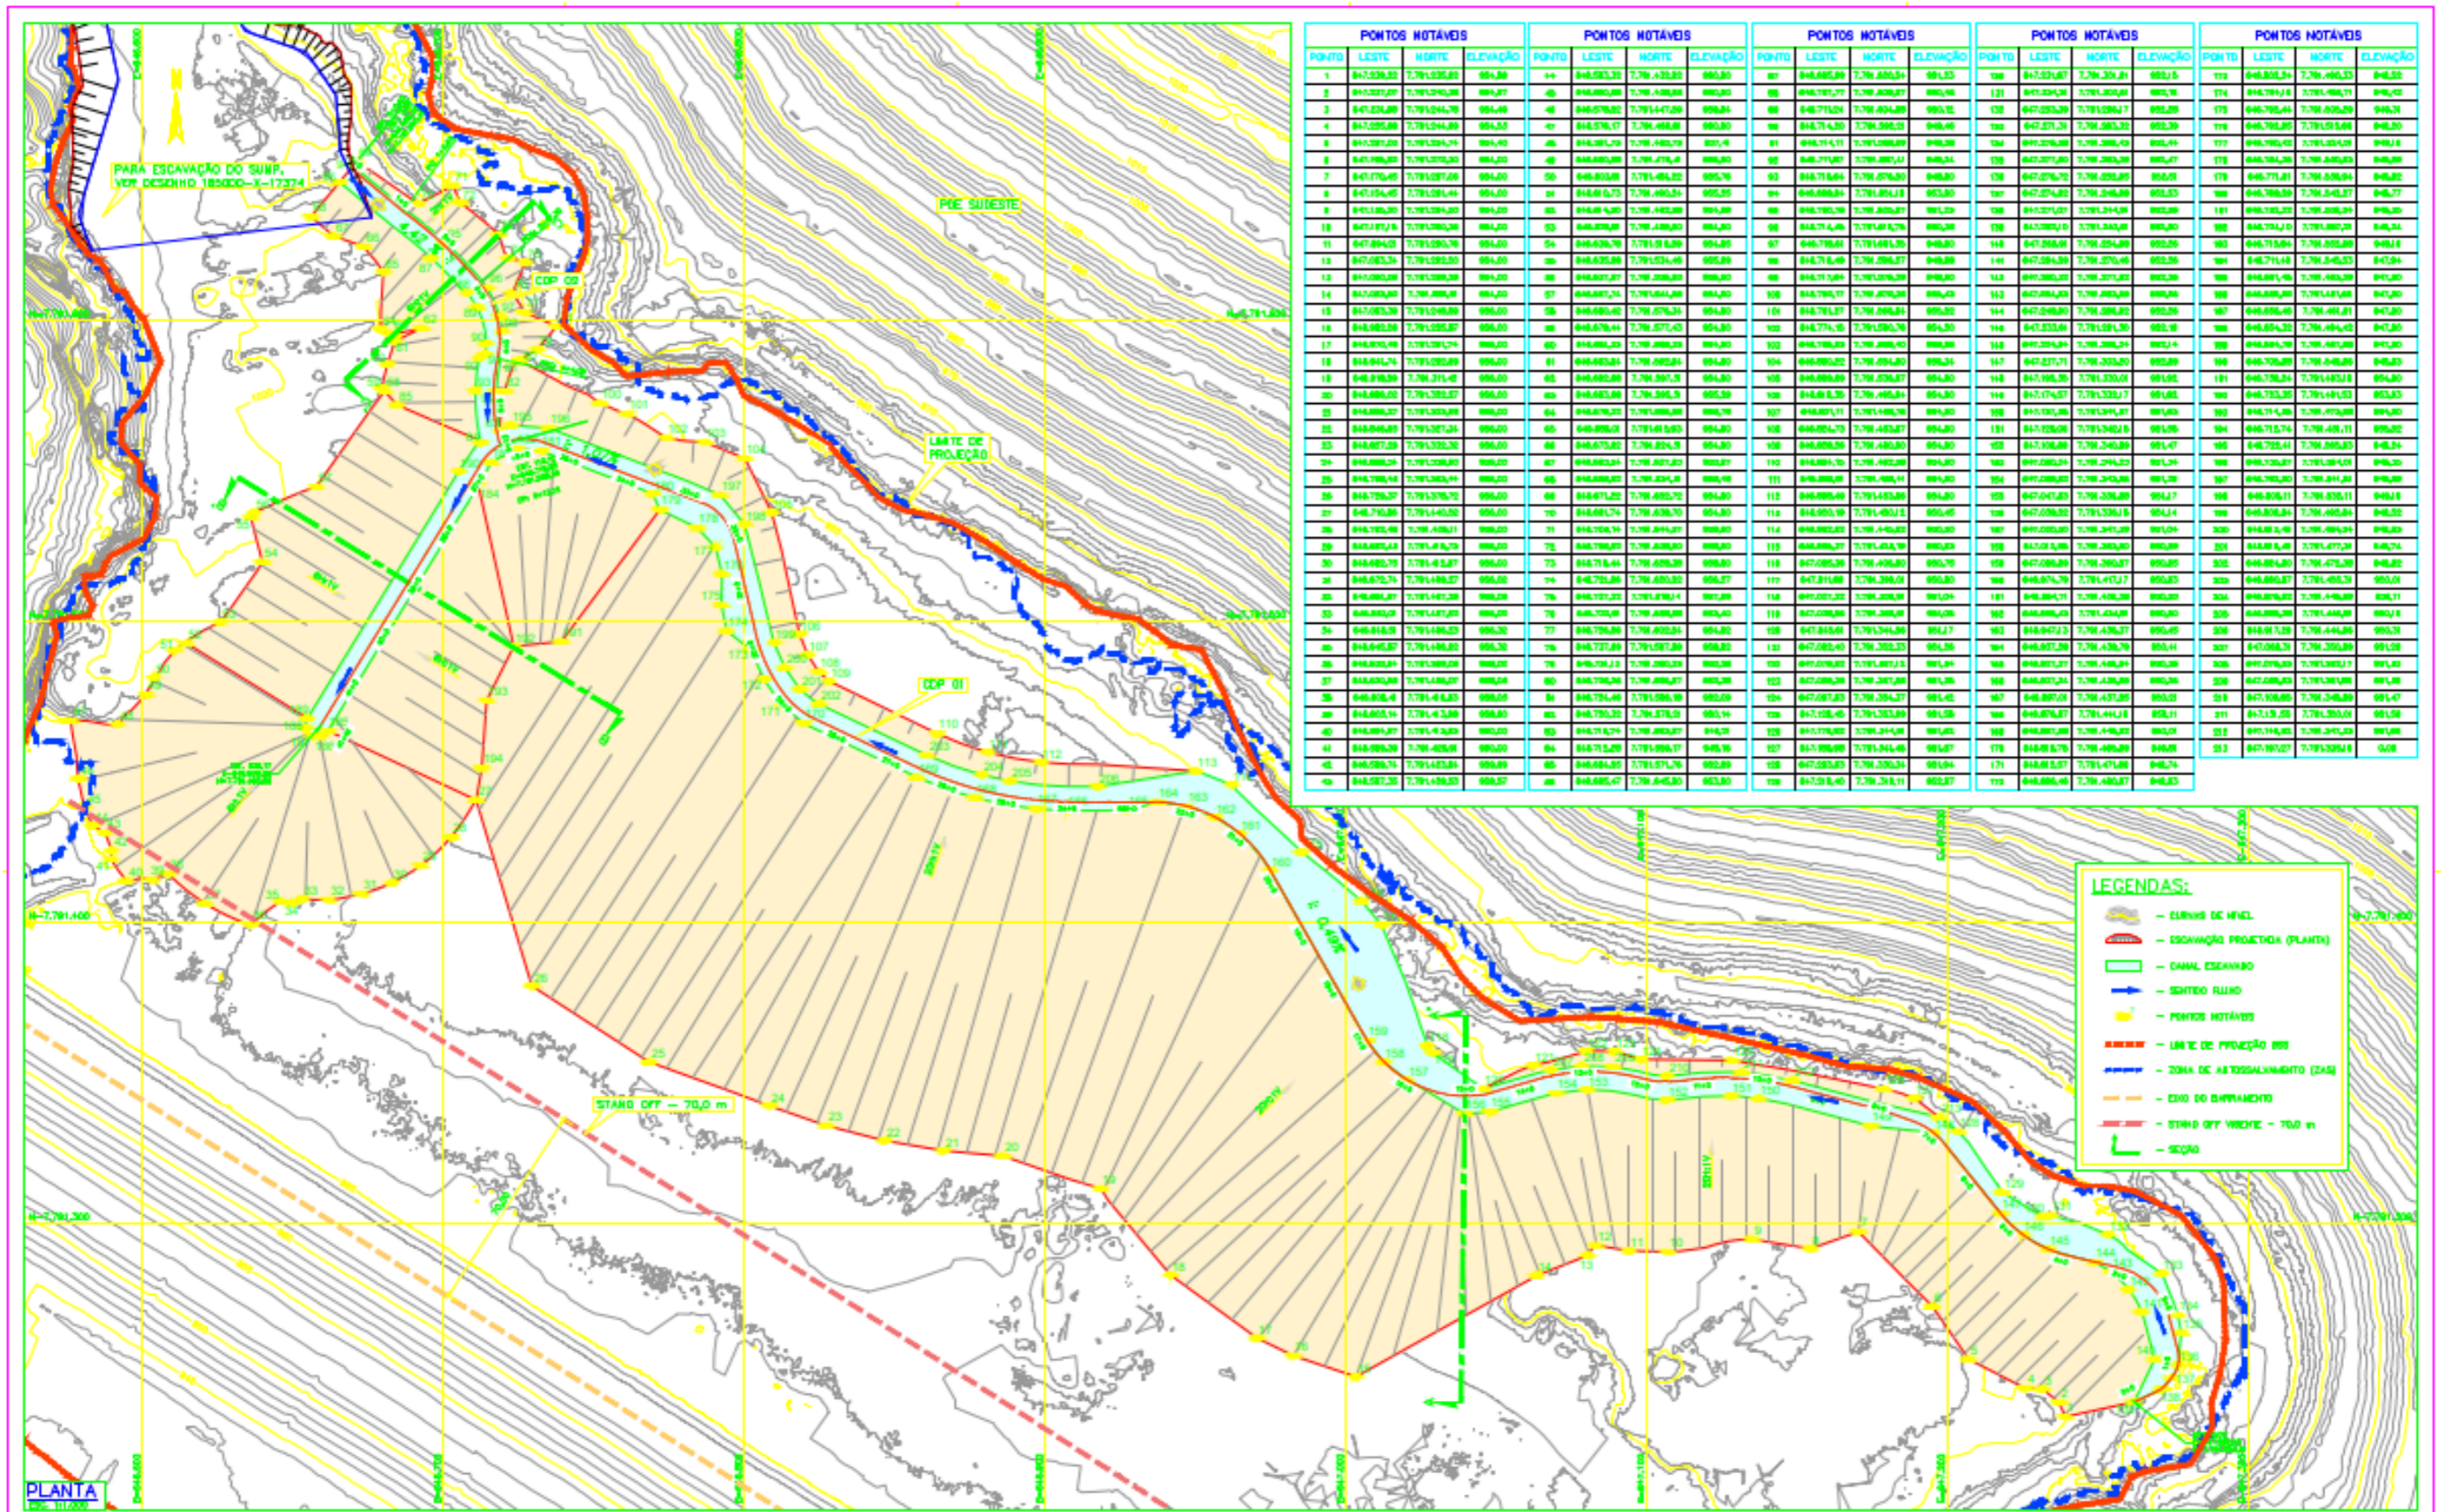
Planta de instrumentação 1850DD-X-17514- As Builts (dezembro/2023).
